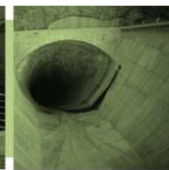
Área de construção do sistema de tratamento de esgoto do município
